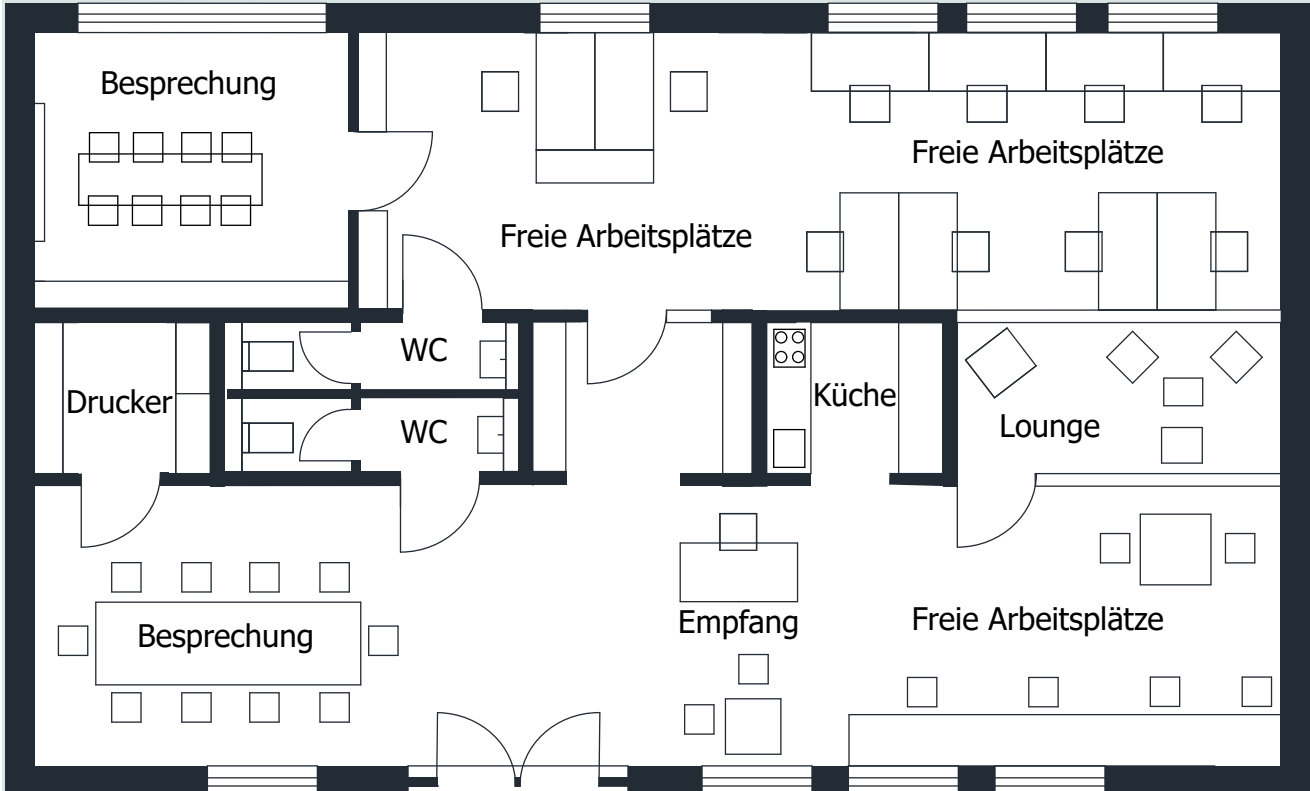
Beispiel Grundriss für Coworking Space (Eigene Darstellung, 2020)
